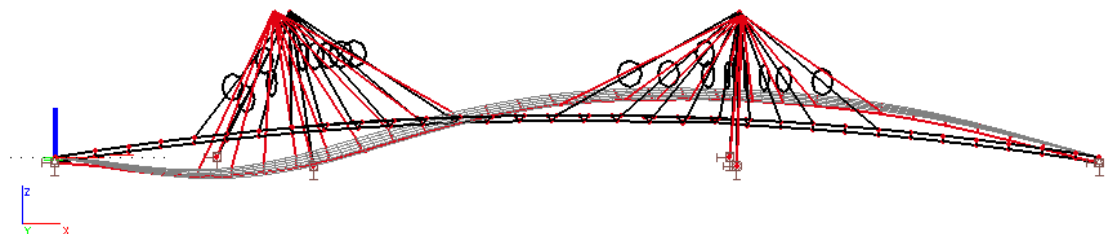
Deformovaná konstrukce po ochlazení lan
